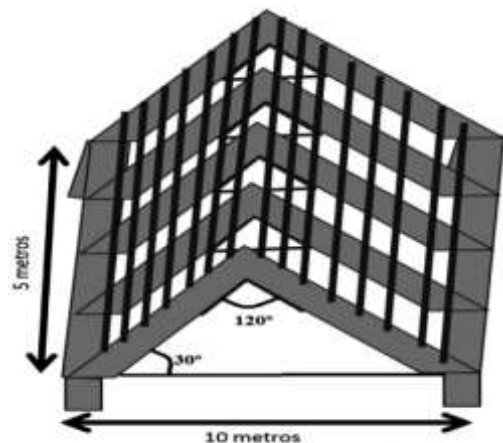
Croqui da Estrutura Metálica da casa de Luís Gerônimo
